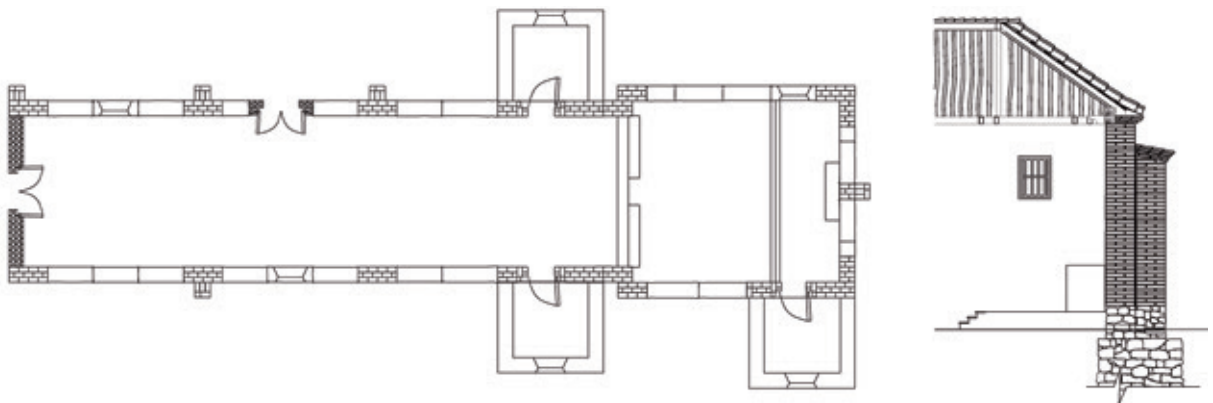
Traza de la iglesia de Sora-Furaquirá-Capitanejo de Motavita, con algunos contrafuertes en adobe. Planta general y corte del muro testero³².
